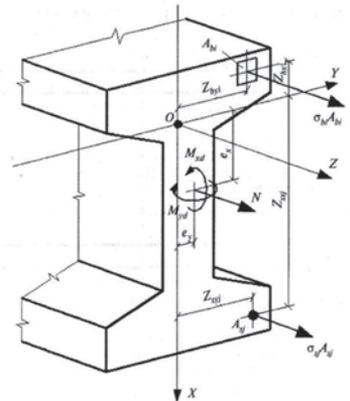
Расчетная схема нормального сечения железобетонного элемента по деформационной модели по СП 52-101-2003
